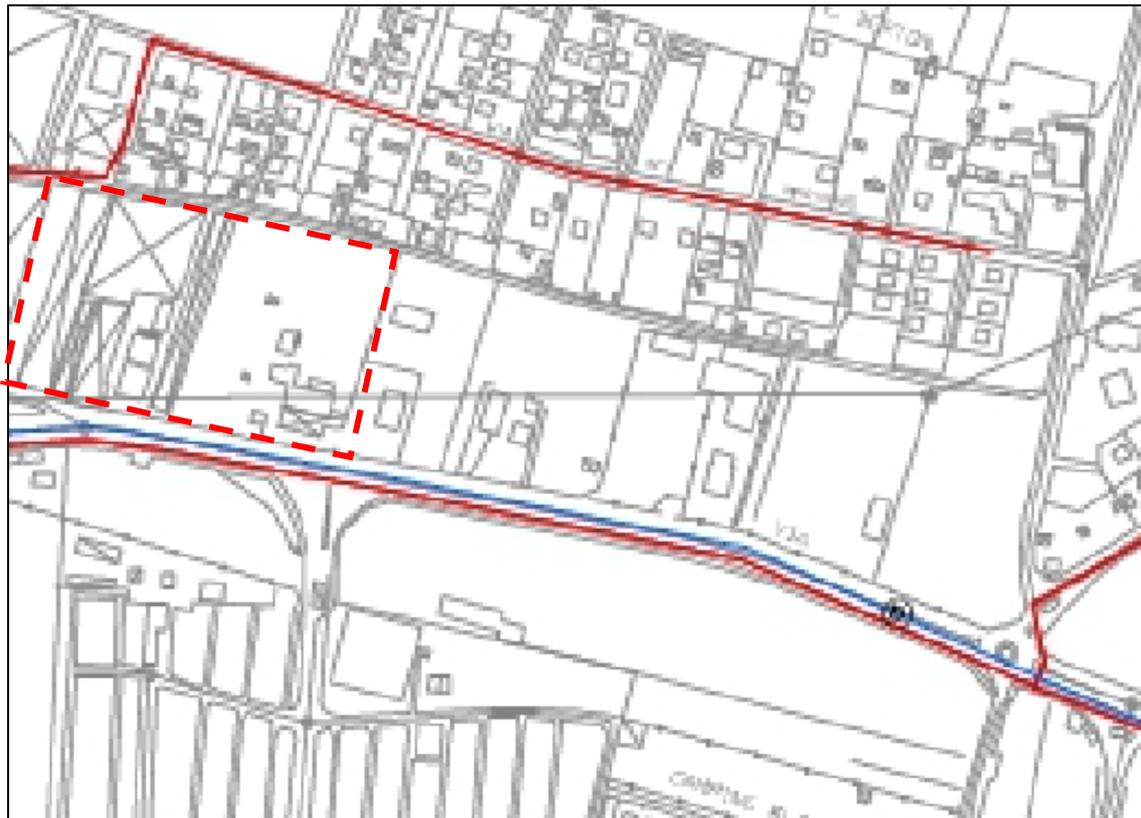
Estratto dalla Rete fognaria del Piano delle Acque.
